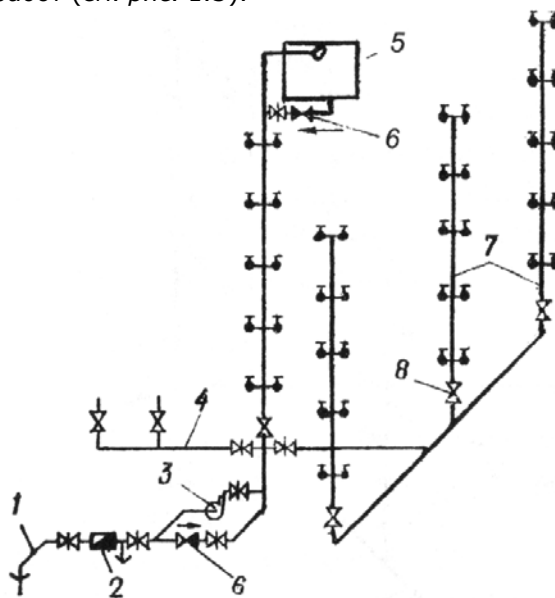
Система водоснабжения здания с водонапорным баком и повысительным насосом:
